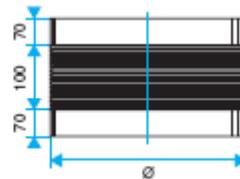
Exemple de pièce de raccordement préfabriquée entre caisson et conduit (document ALDES)
